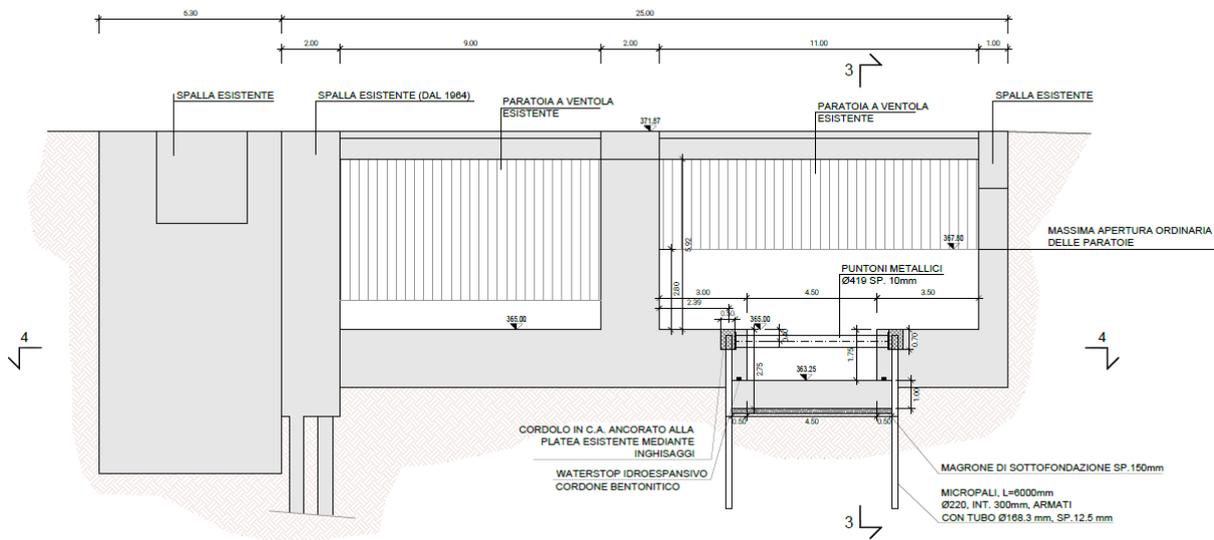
Sezione di intervento di adeguamento della traversa esistente nel PE
